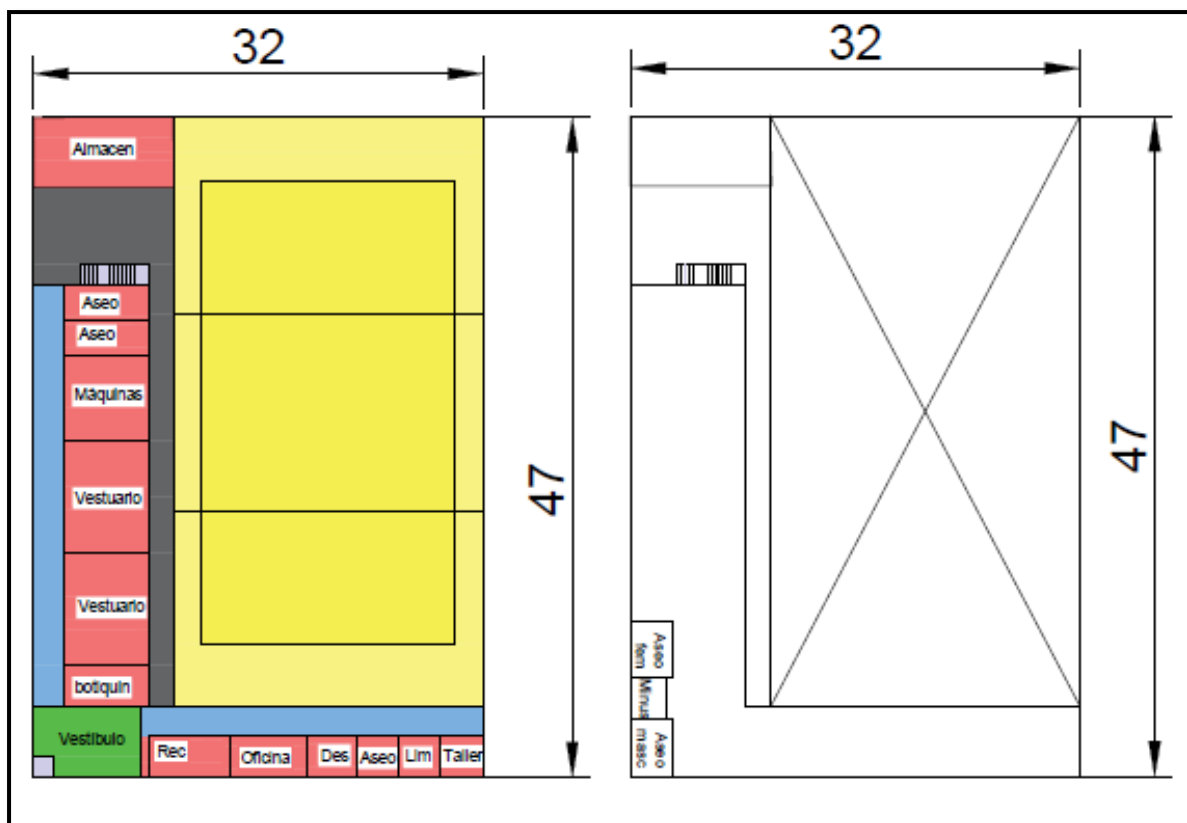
Distribución de los espacios de la alternativa 3. Planta baja (izquierda) y Planta 1 (derecha). (Fuente: Elaboración propia).
